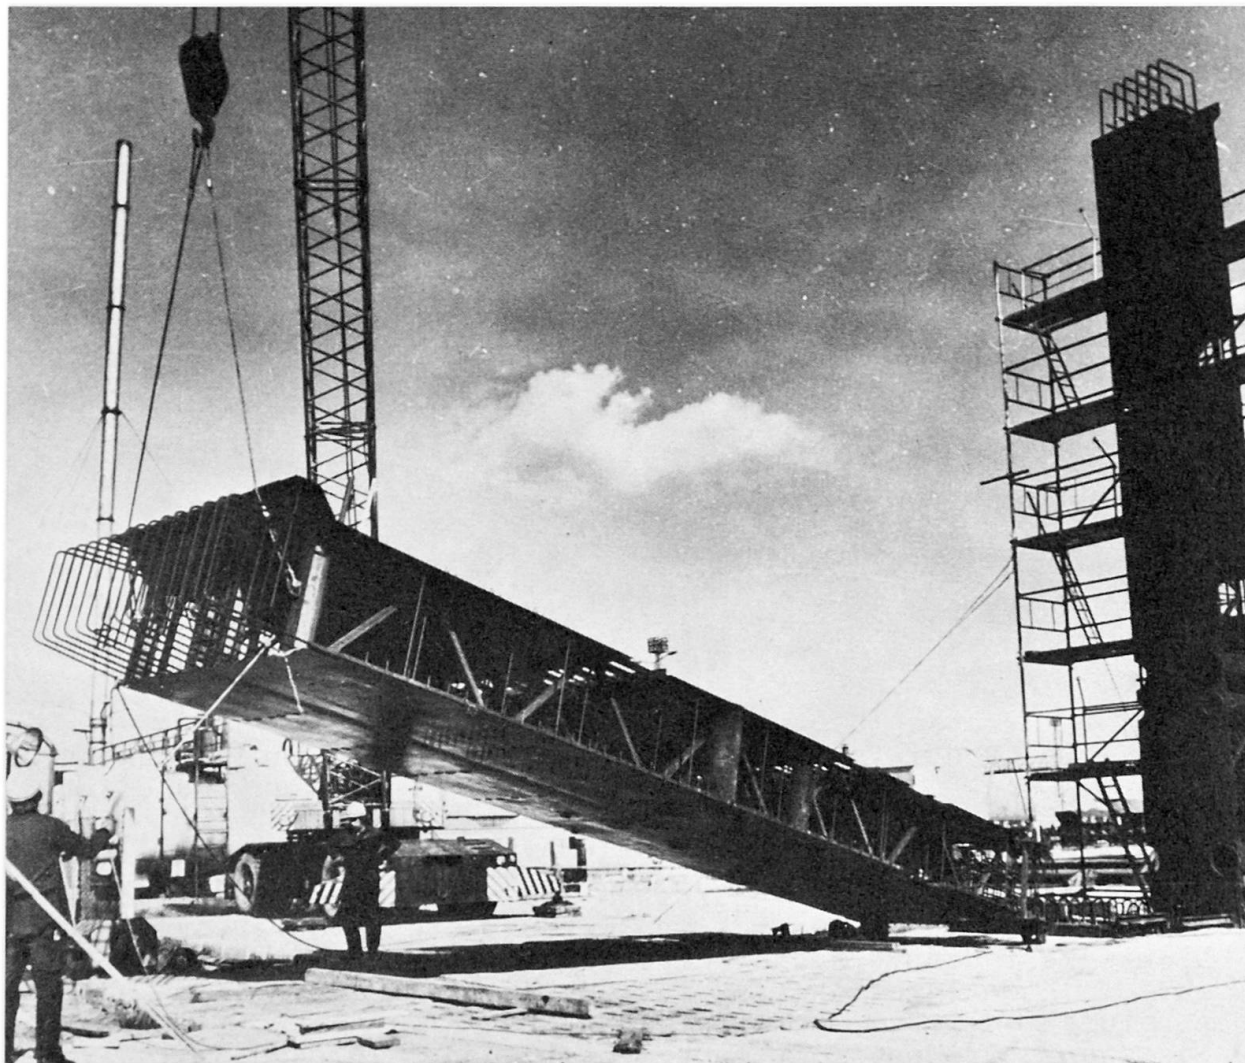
Montageversuch am Originalausschnitt einer Reaktorbox
